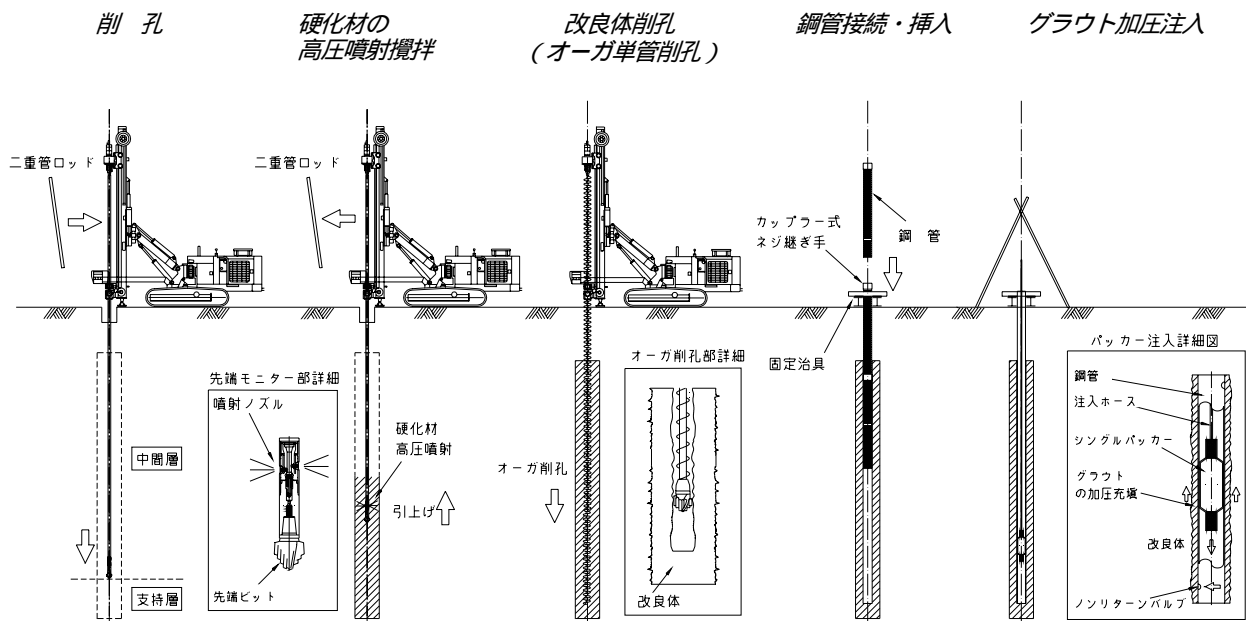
ST マイクロパイル タイプ の標準的な施工手順
